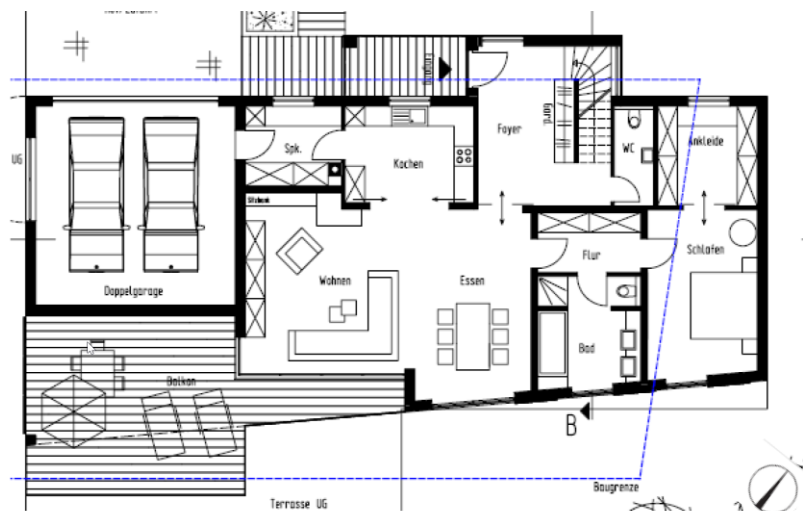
Grundriss Erdgeschoss (Quelle: Architekturbüro N. Hoffmann)
